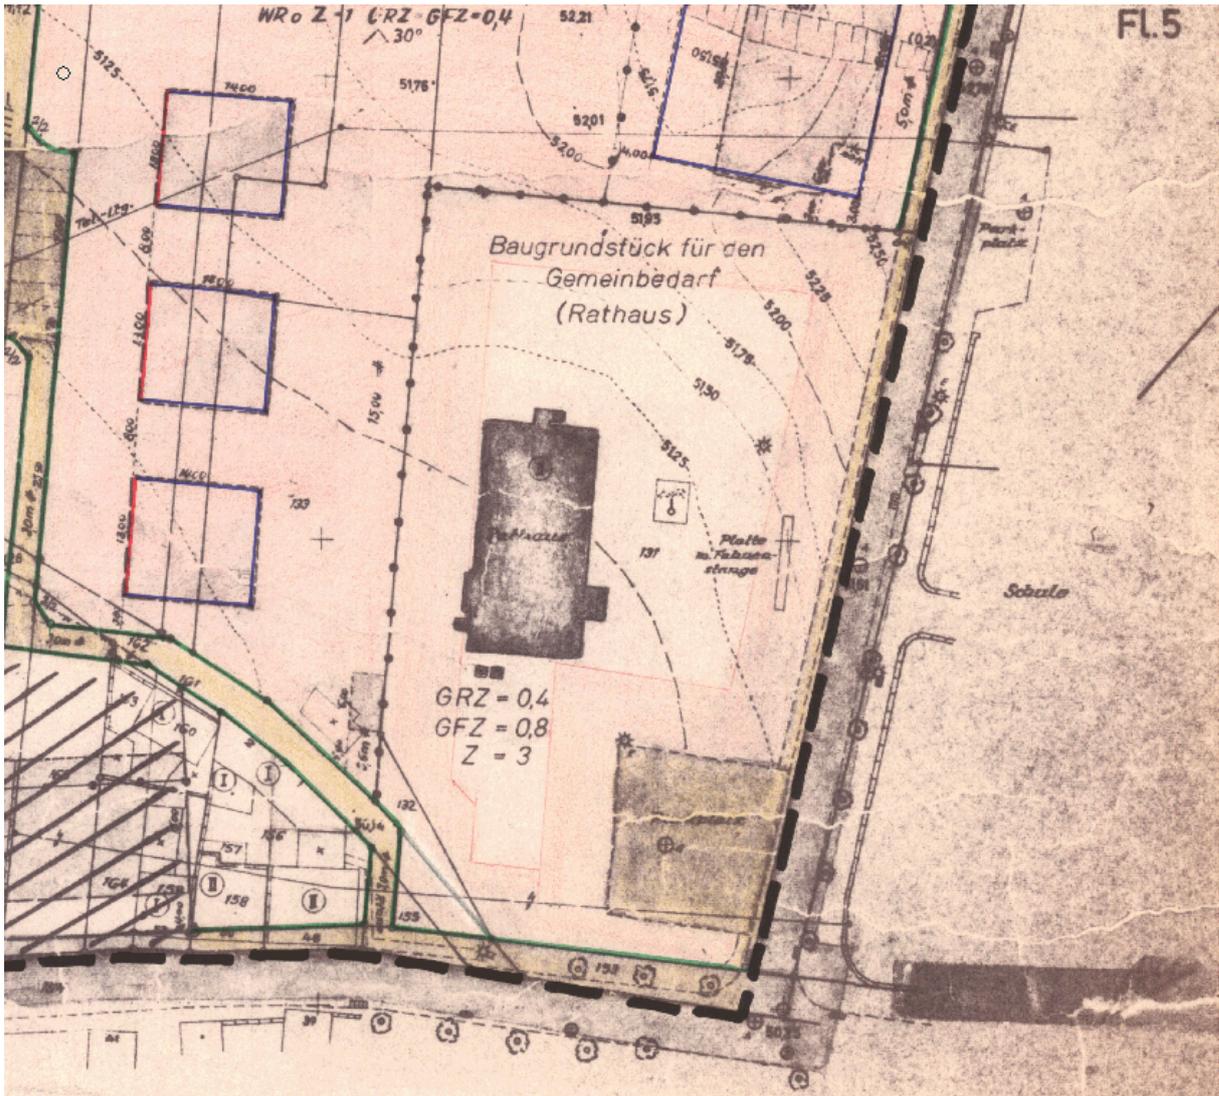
Auszug dem Bebauungsplan Nr. K 2 „Zwischen Friedrichstraße und Friedhof Stifterstraße“
